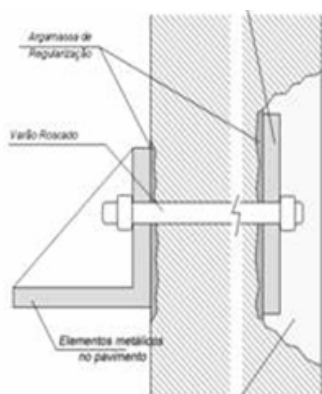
Pormenor de ligação da estrutura de suporte às paredes do saguão (adaptado de [34]).
